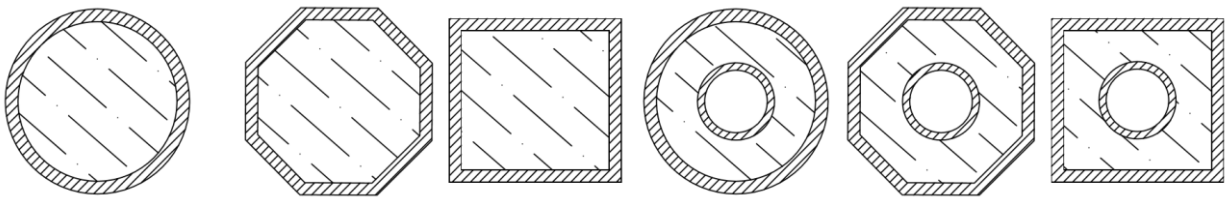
Види поперечних перерізів сталобетонних елементів
